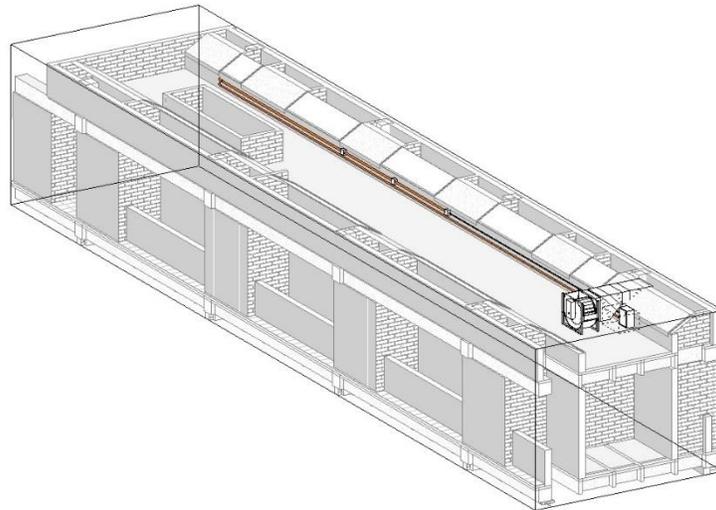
Recorrido de tuberías eléctricas y ubicación del ventilador y tablero de arranque en terraza técnica costado sur – b19).
